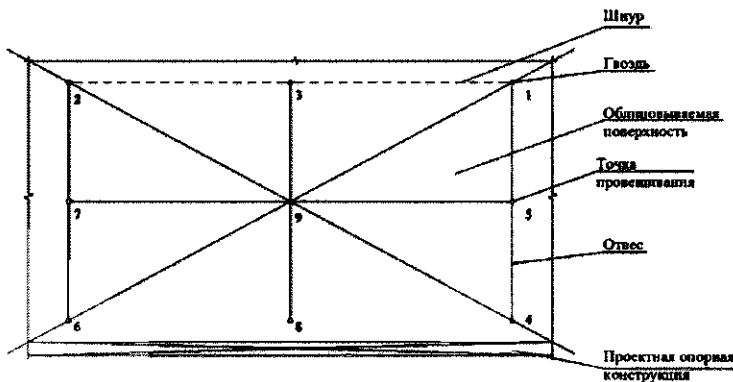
Схема расположения точек крепления отвесов при провешивании облицовываемой поверхности стены
